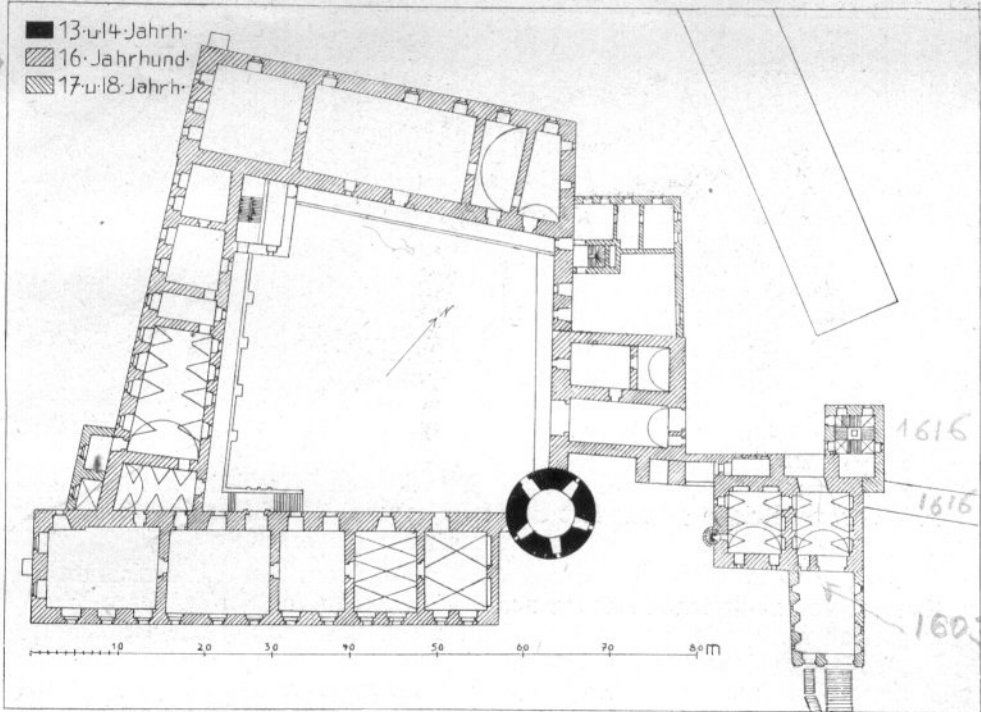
Schloß in Oels. Grundriß des Erdgeschosses.
